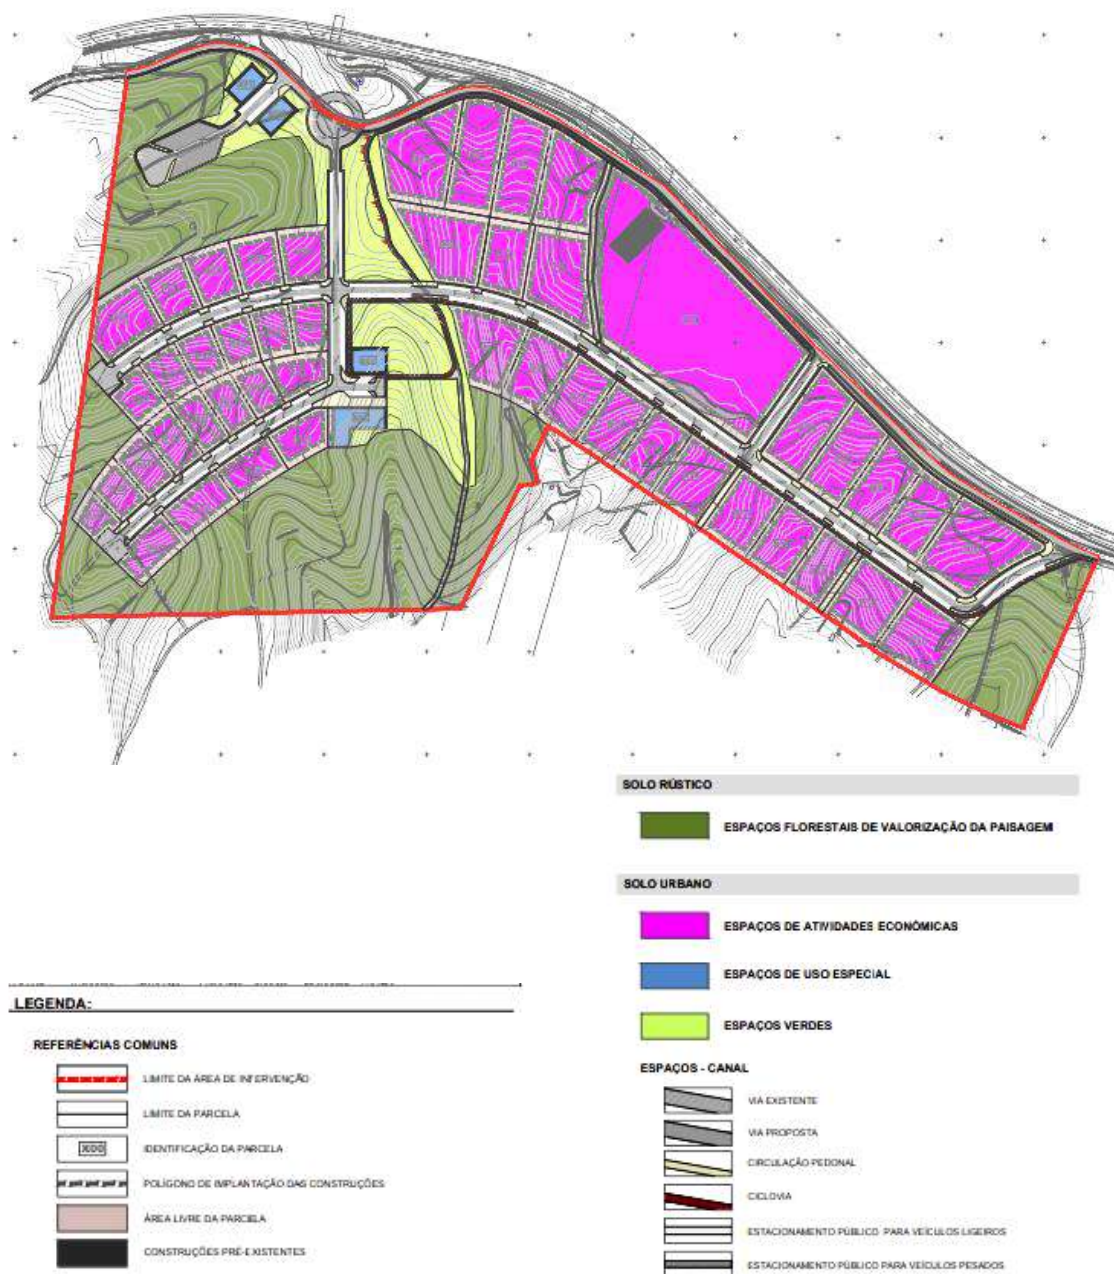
Planta de Implantação da proposta preliminar do Plano de Pormenor, 2022
